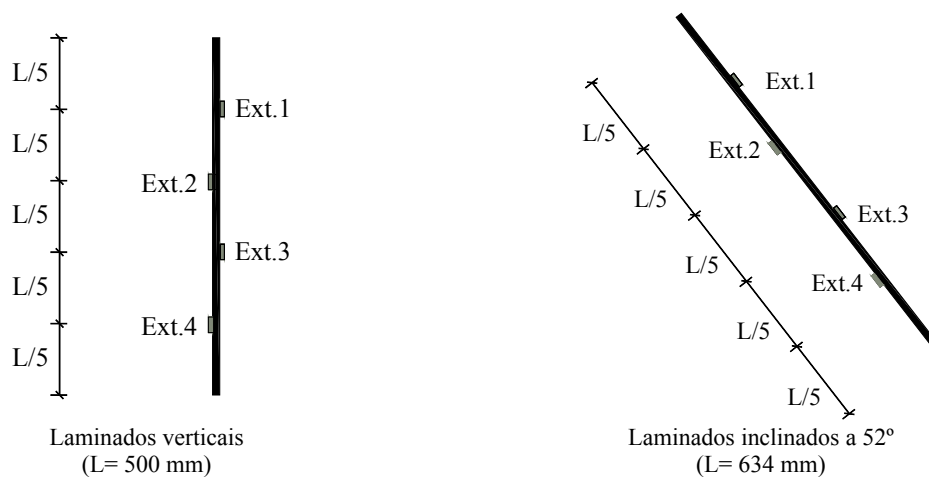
Disposição dos quatro extensómetros aplicados nos laminados de CFRP instrumentados (Ext.1, Ext.2, Ext.3 e Ext.4).
